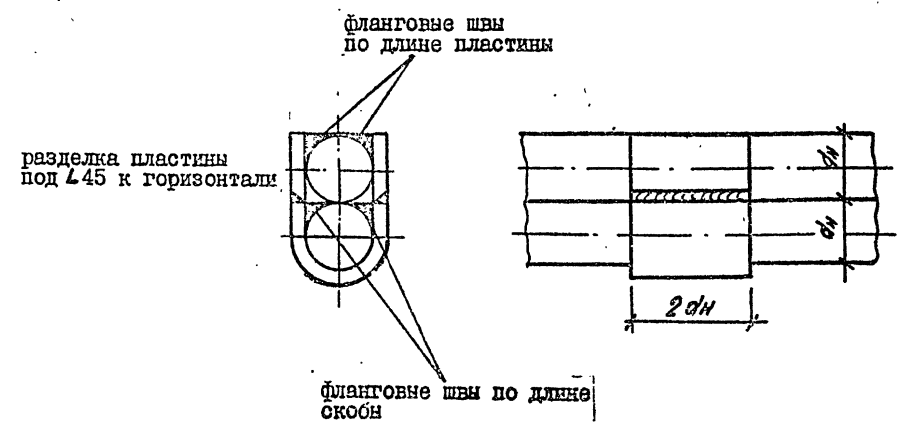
Конструкция сварного соединения спаренных стержней арматуры, выполненного одноэлектродной сваркой на стальных скобах.
